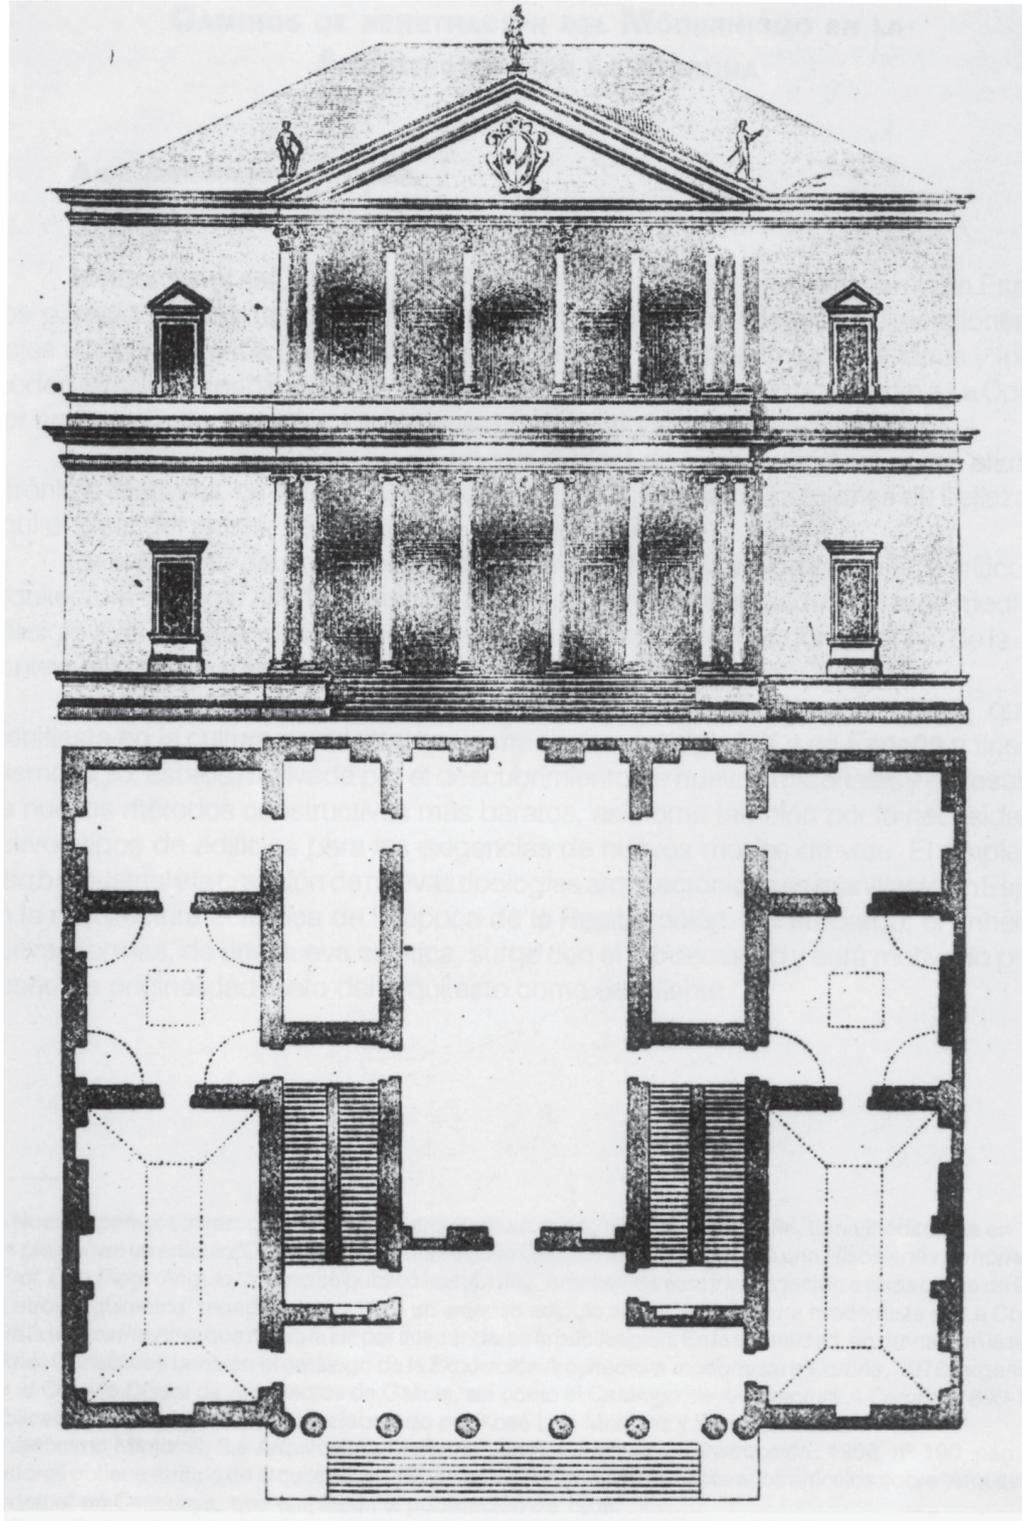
Palladio. Planta y fachada principal de la villa Sarego della Miega.
